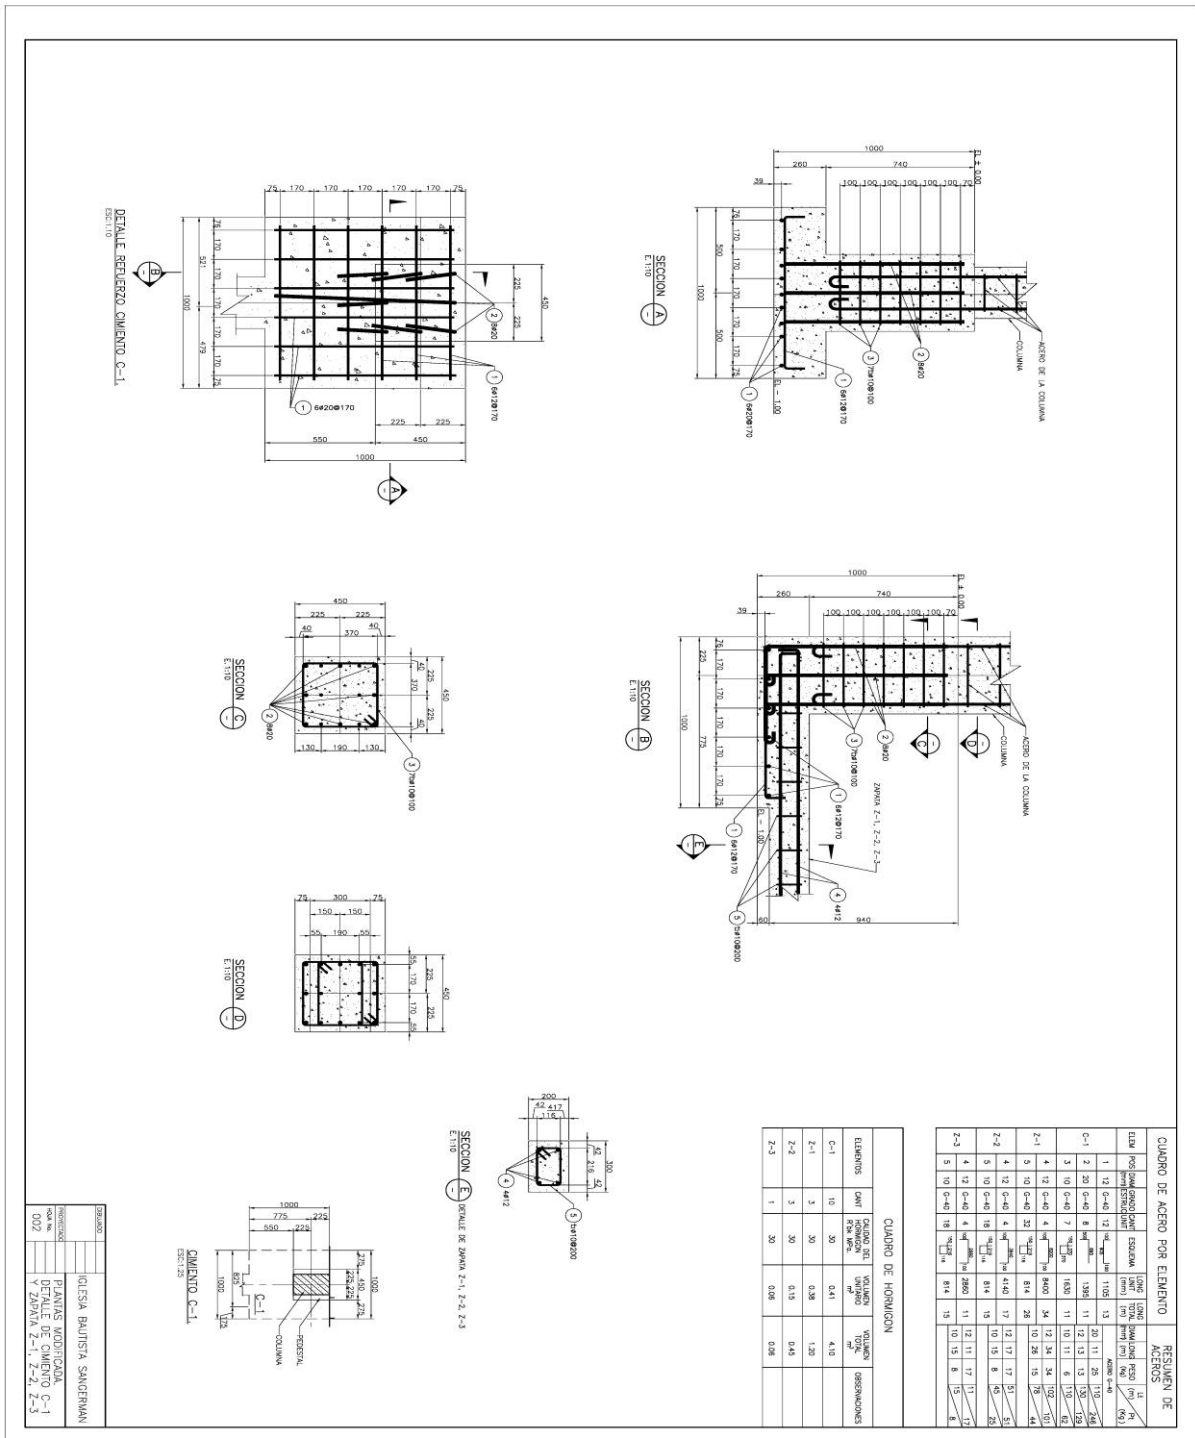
Plano de la cimentación realizada en el proyecto anterior.
